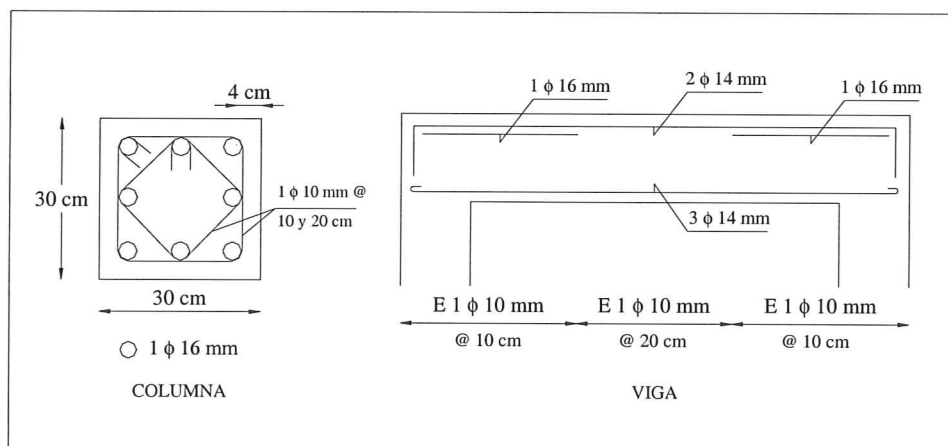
Armadura de columnas y vigas de la estructura de figura 1.13.
